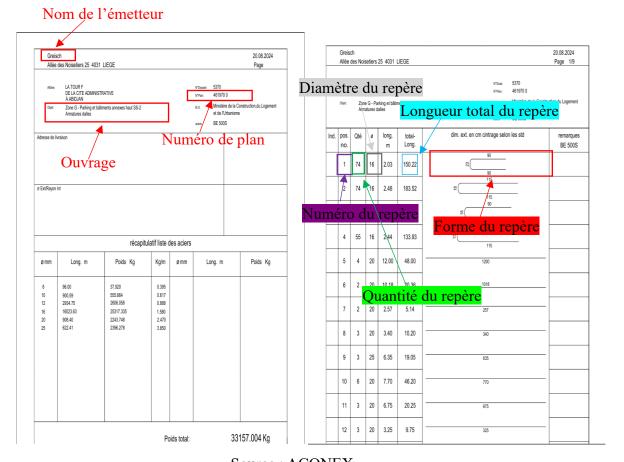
Bordereau d'acier du plan 461920 de la zone B et C
